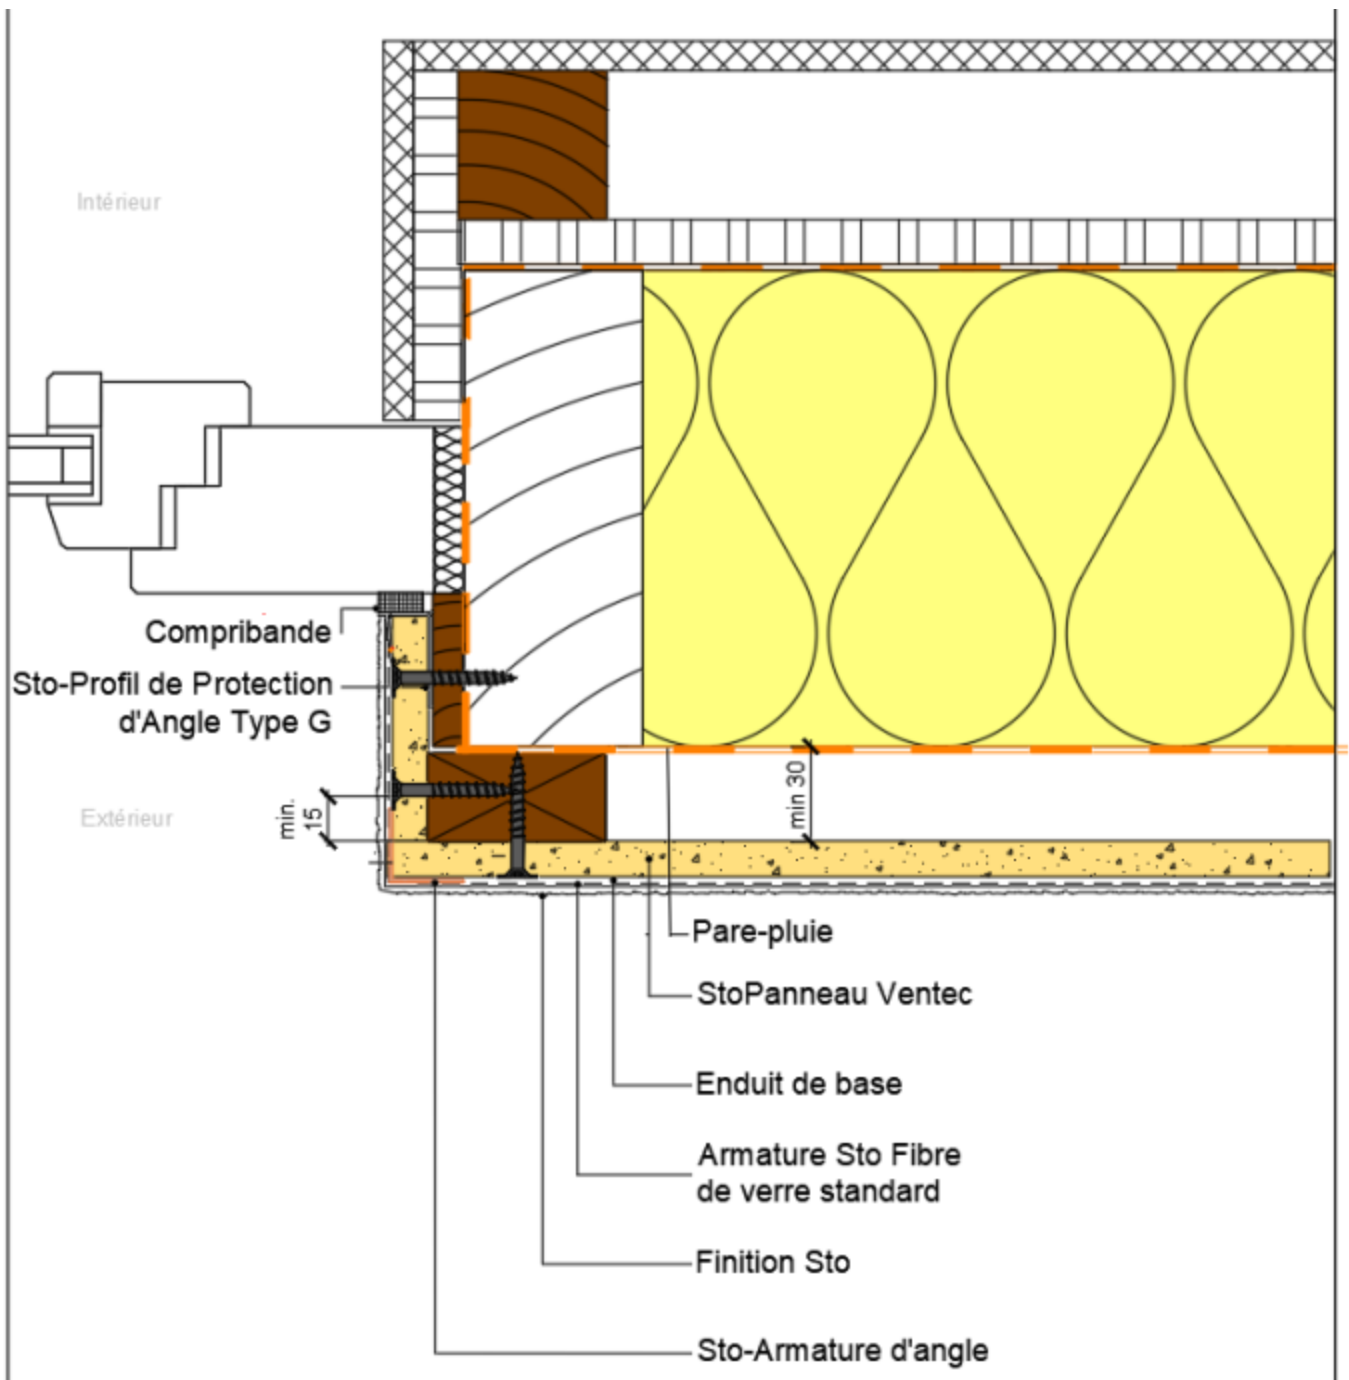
Coupe horizontale - Menuiserie posée en tunnel - Traitement de tableau non isolé en retour de parement - Ossatures bois sur COB
